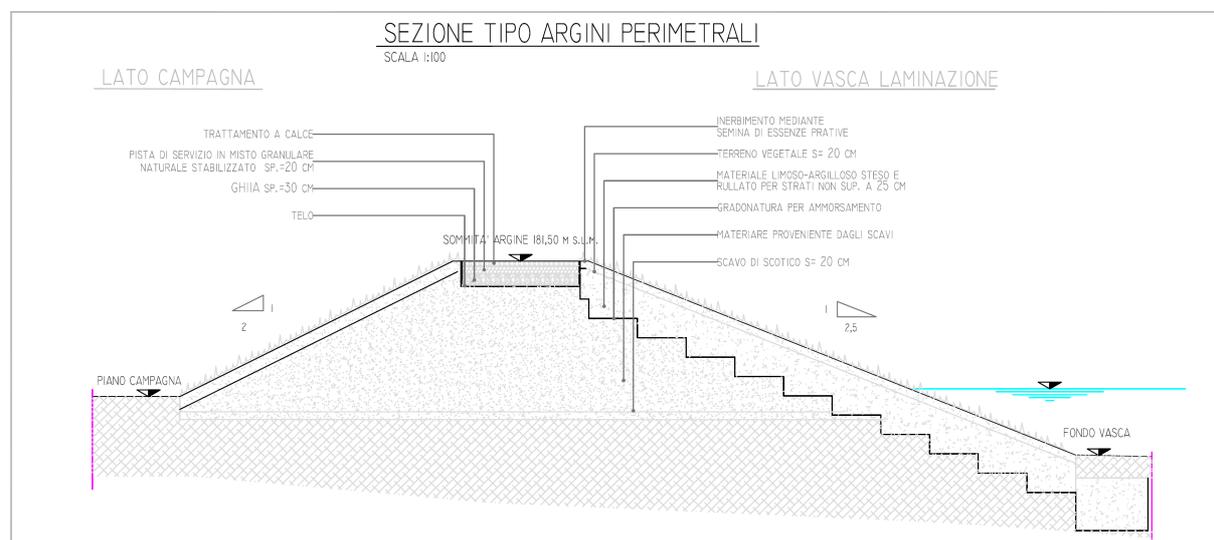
Sezione-tipo dell'arginatura perimetrale – progetto definitivo (9/2014)
